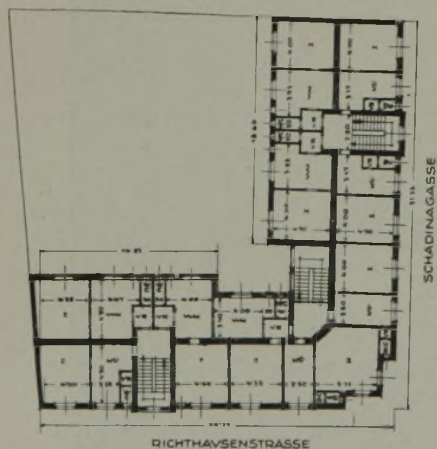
Grundriß Richthausenstr. (1 : 600.)
